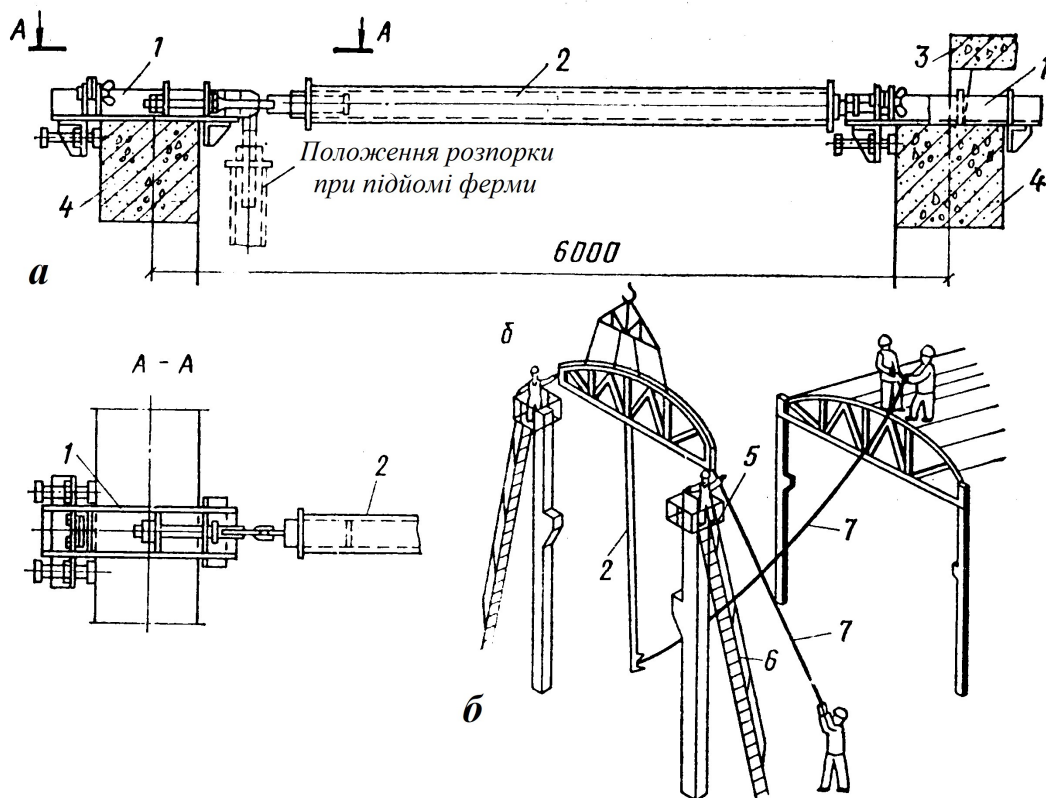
Пристрій для монтажу ферм: а – розпорка для закріплення ферм; б – підйом розпорки; 1 – струбцина; 2 – розпорка; 3 – плита покриття; 4 – верхній пояс ферми; 5 – площадка; 6 – сходи; 7 – прядив'яна мотузка
